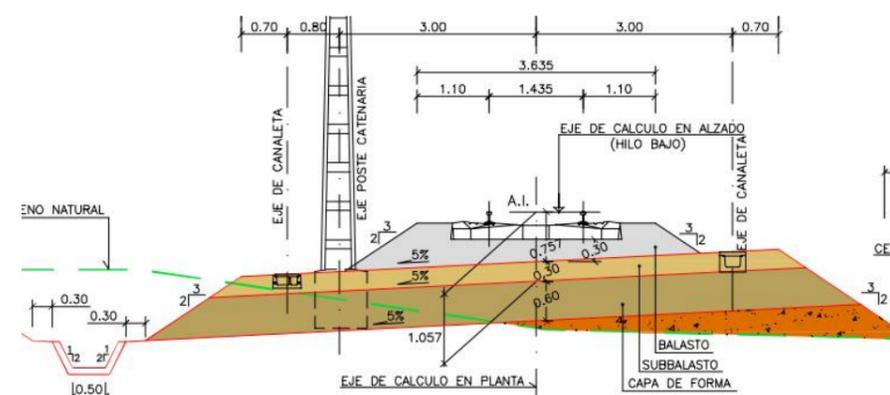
SECCIÓN TIPO EN VÍA ÚNICA A.I.
